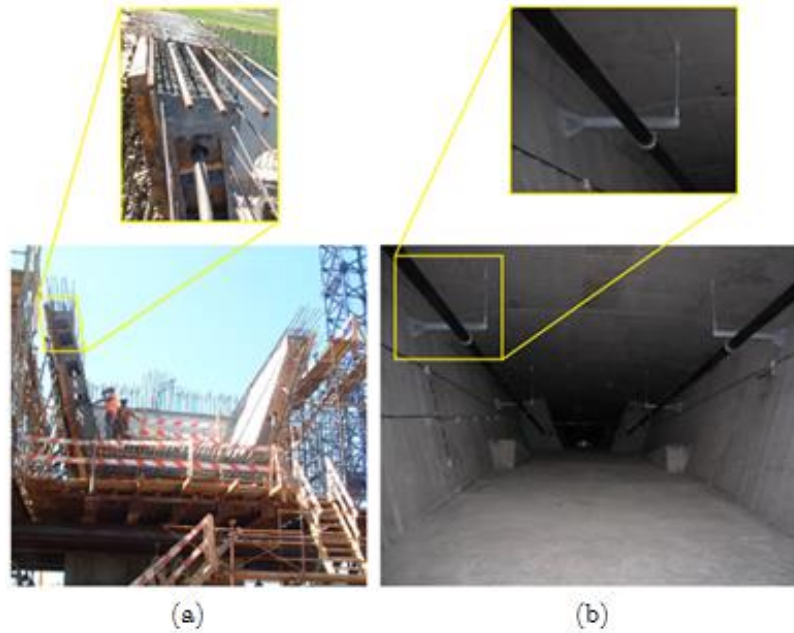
(a) Pormenor de pré-esforço consola; (b) Pormenor de pré-esforço exterior
